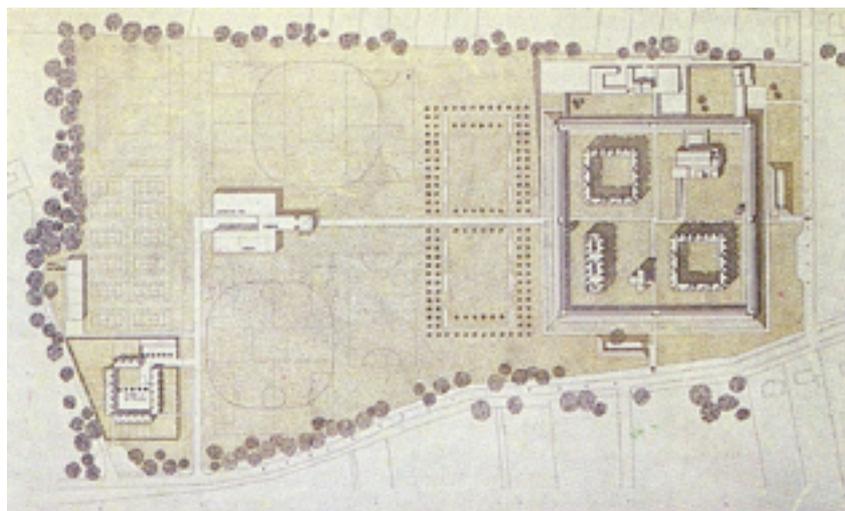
James Stirling y James Gowan. Churchill College, Cambridge. Planta segunda. *James Stirling. Building and Projects*. Rizzoli. Nueva York, 1984.
